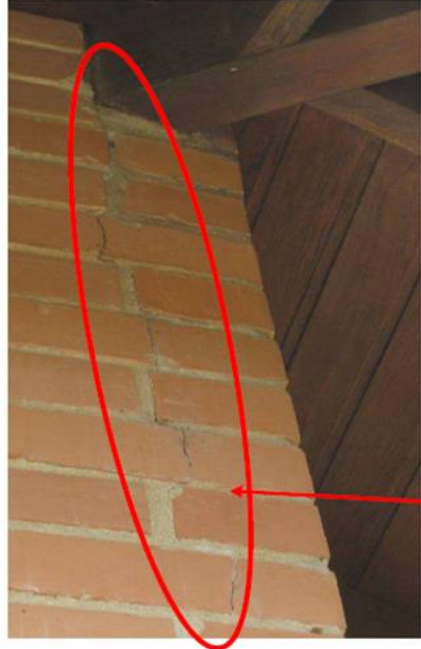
Mampostería fisurada en apoyo de viga.
